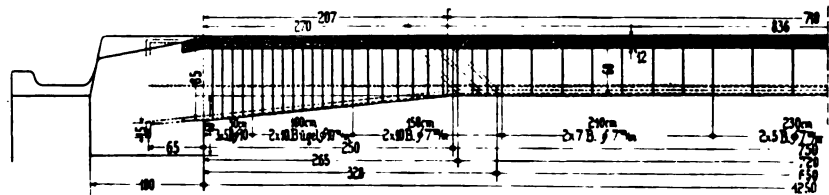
Armierungsplan der Eindeckung bei der Stiege Rotenturmstraße.
